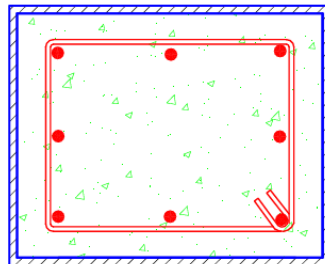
Sección de un miembro compuesto relleno con armadura longitudinal de refuerzo. Recuperado de: (Crisafulli, 2018).
